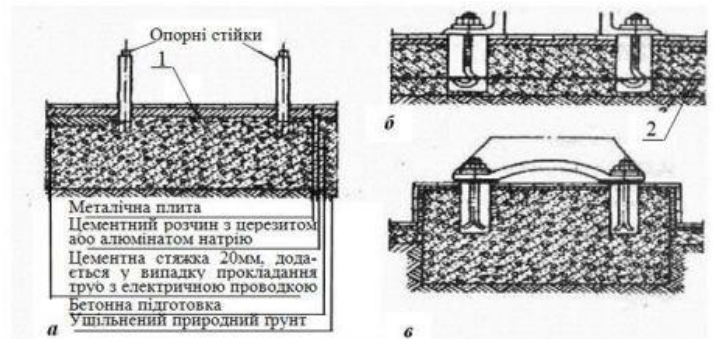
Способи кріплення обладнання на підлозі та фундаменті:
